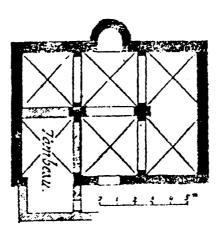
مسقط أفقي لجامع اشبيليه الموحدى . (عن : تيراس) .
